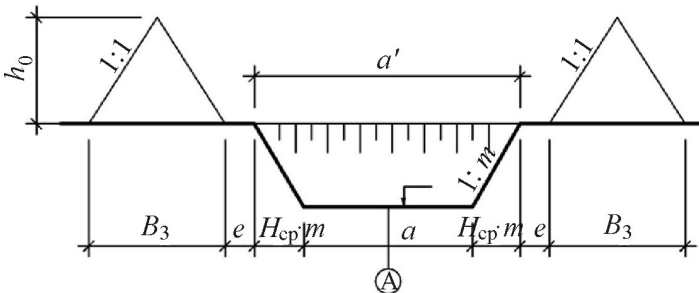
Расчетная схема двухстороннего размещения отвала при разработке траншеи (котлована)
